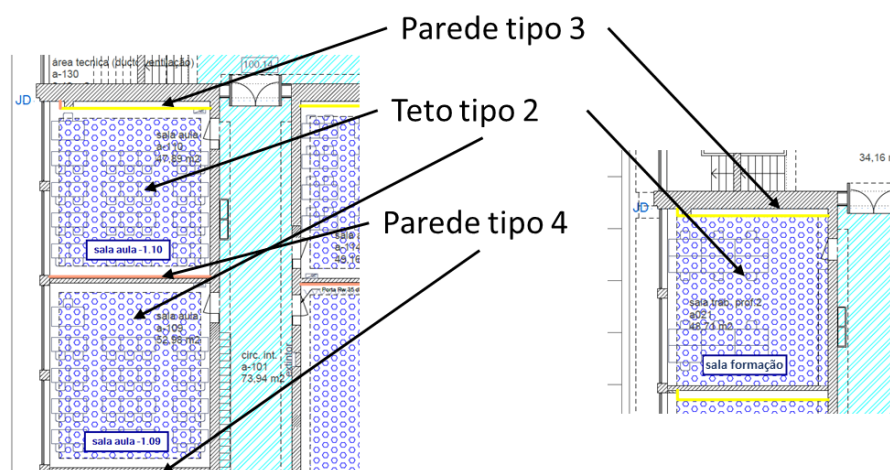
Planta das salas a1.10 e a1.09 com alterações do projeto de acústica [53].
